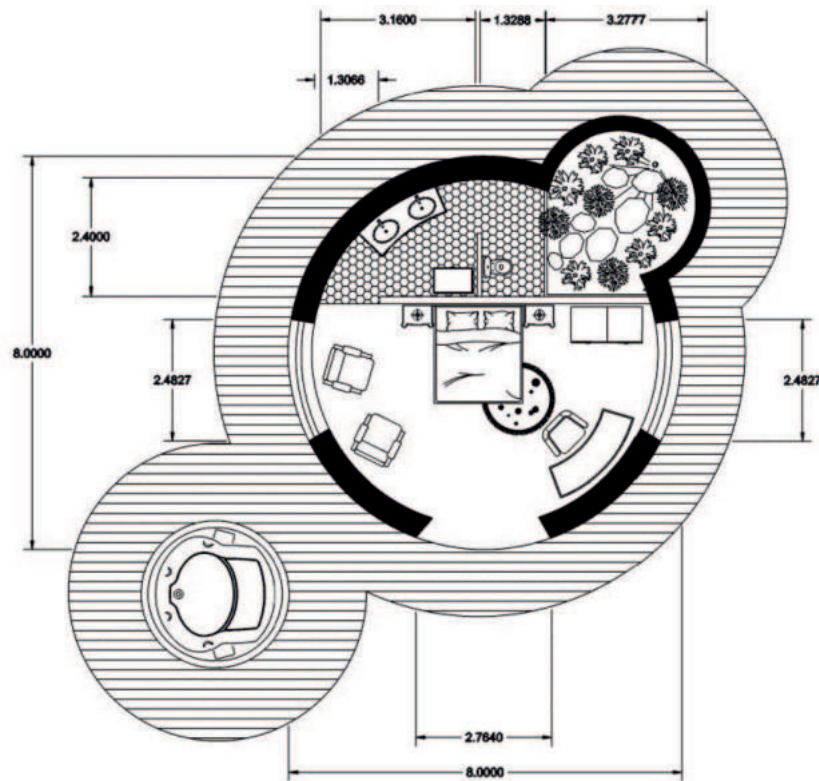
Planta tipo glamping, parador turístico. Fuente: Arq. Laura Arias Gómez. Elaboración: Arq. Laura Arias Gómez
